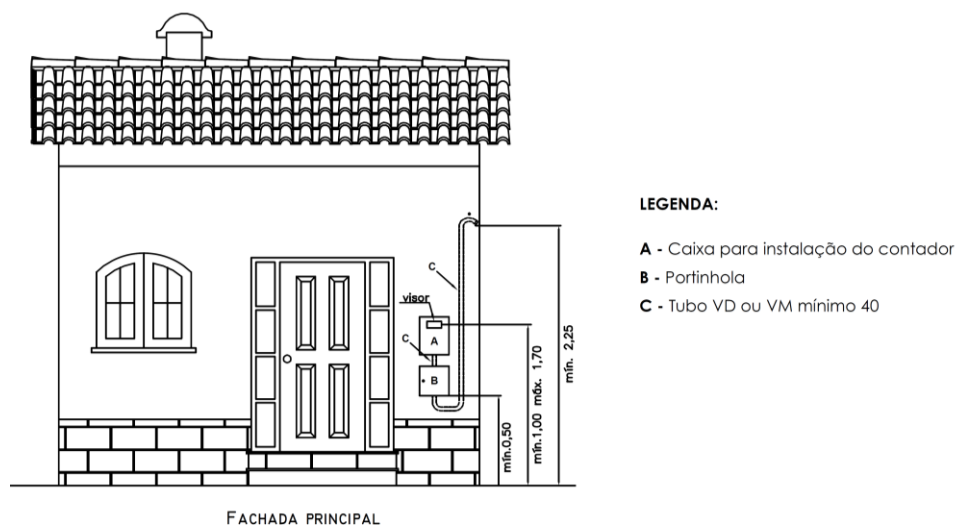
Ligação a partir de rede aérea de edifícios com uma instalação de utilização e fachada confinante com a via pública (sem muro) [10]
